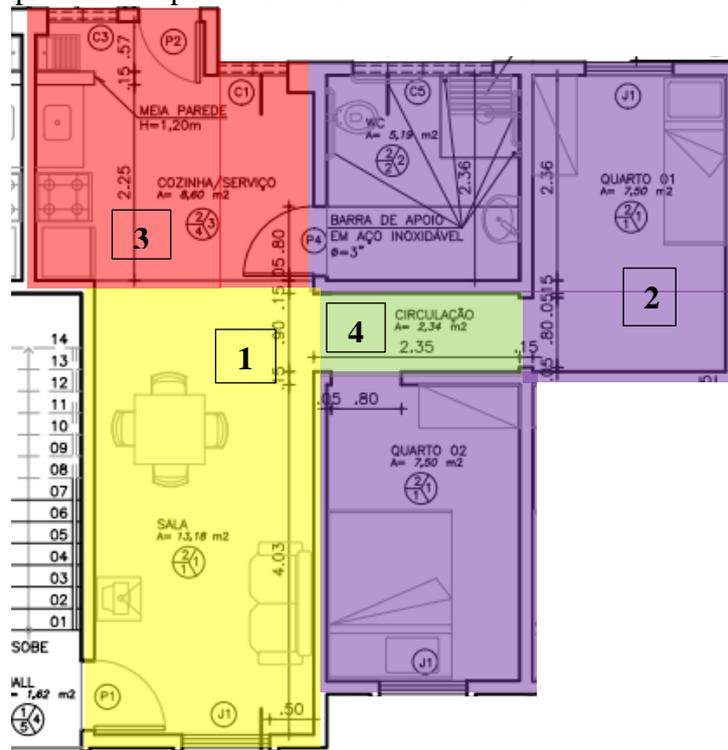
Planta baixa do bloco B5, pavimento superior.
